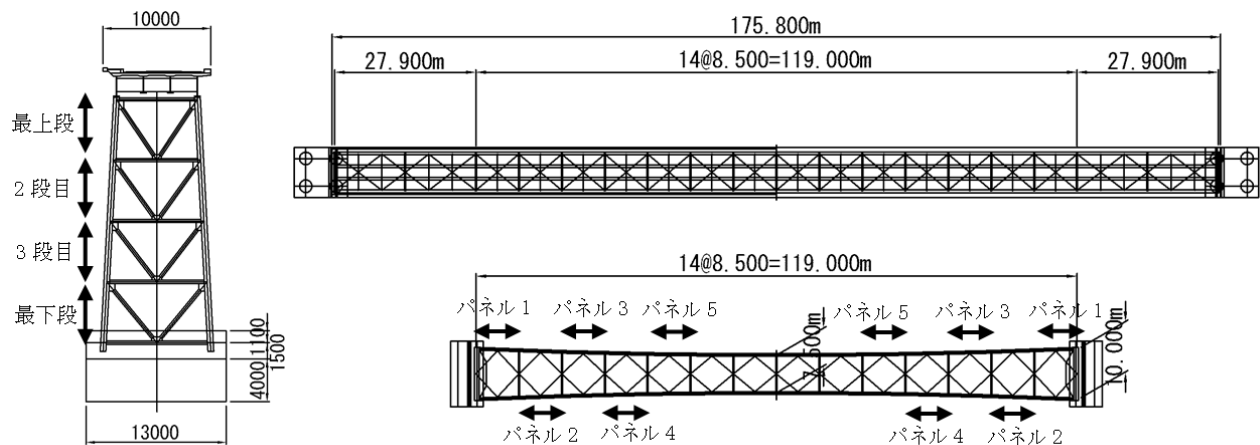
エンドポストの正面図（左）、上部構造の平面図（右上）及びアーチ部（右下）の平面図
